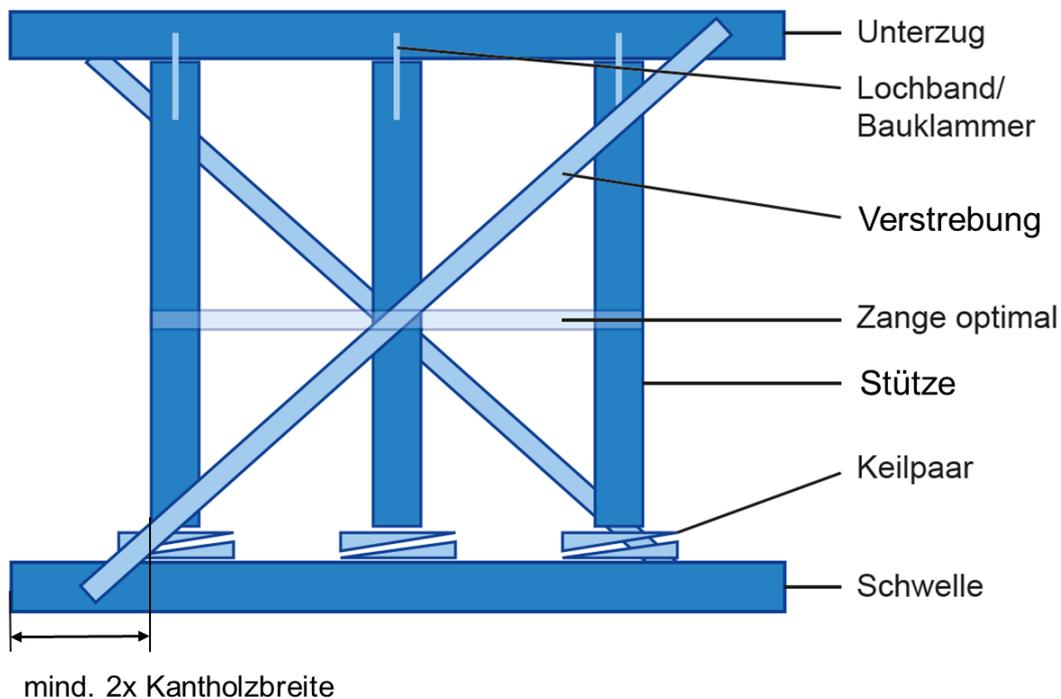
Konstruktion senkrecht Flächenfachwerk aus Holz (Blockhaus, THW)
